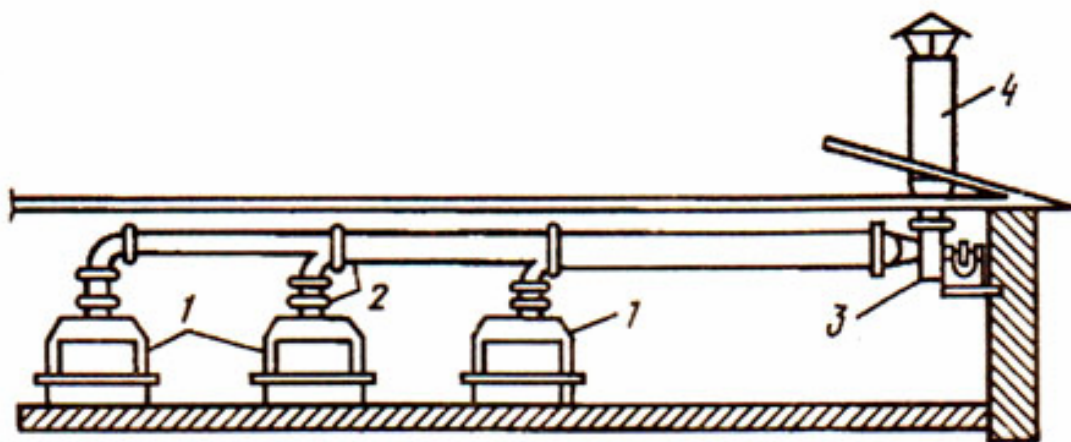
Схема установки местной вытяжной вентиляции:
